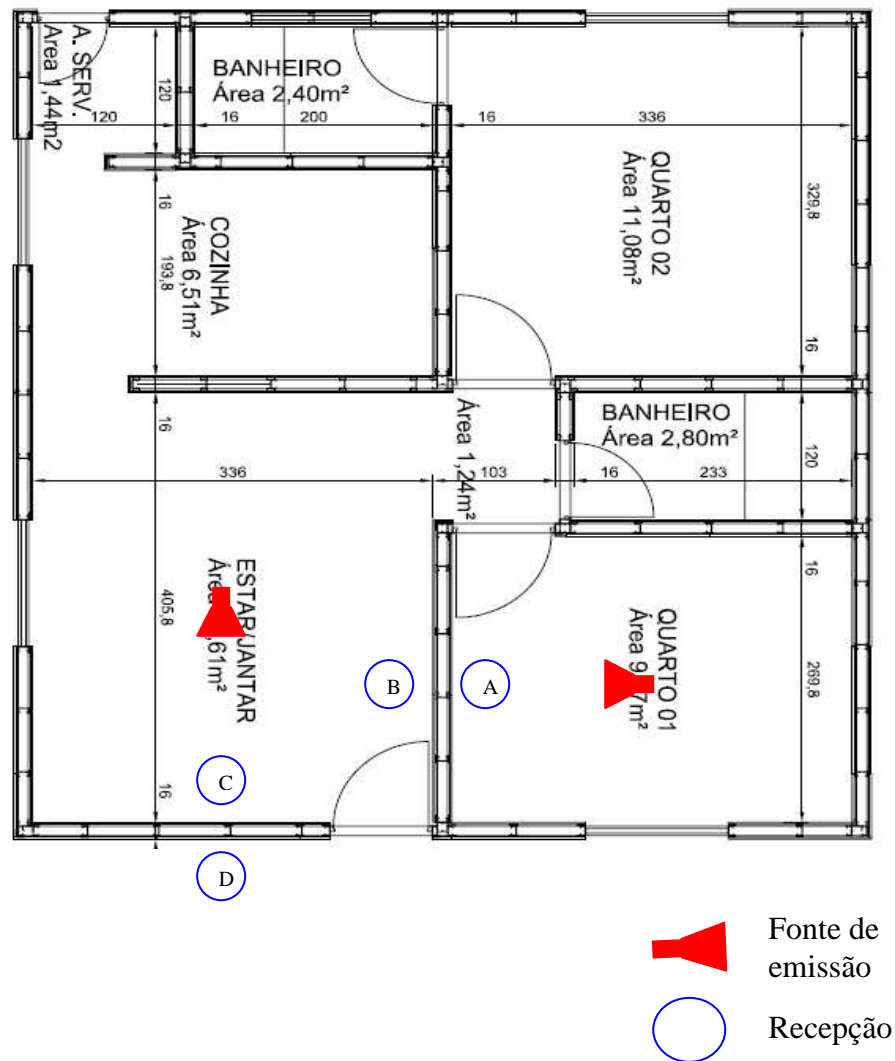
Pontos de emissão e recepção do som, locados na planta baixa.
